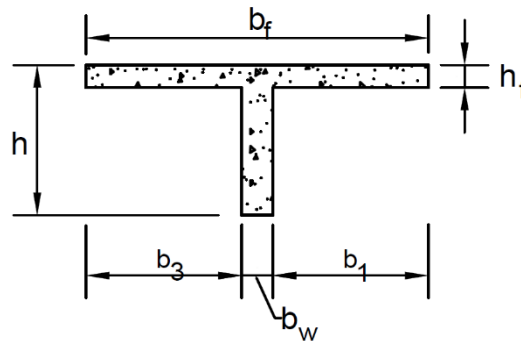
Sección transversal de vigas (Autor propio, 2019).
